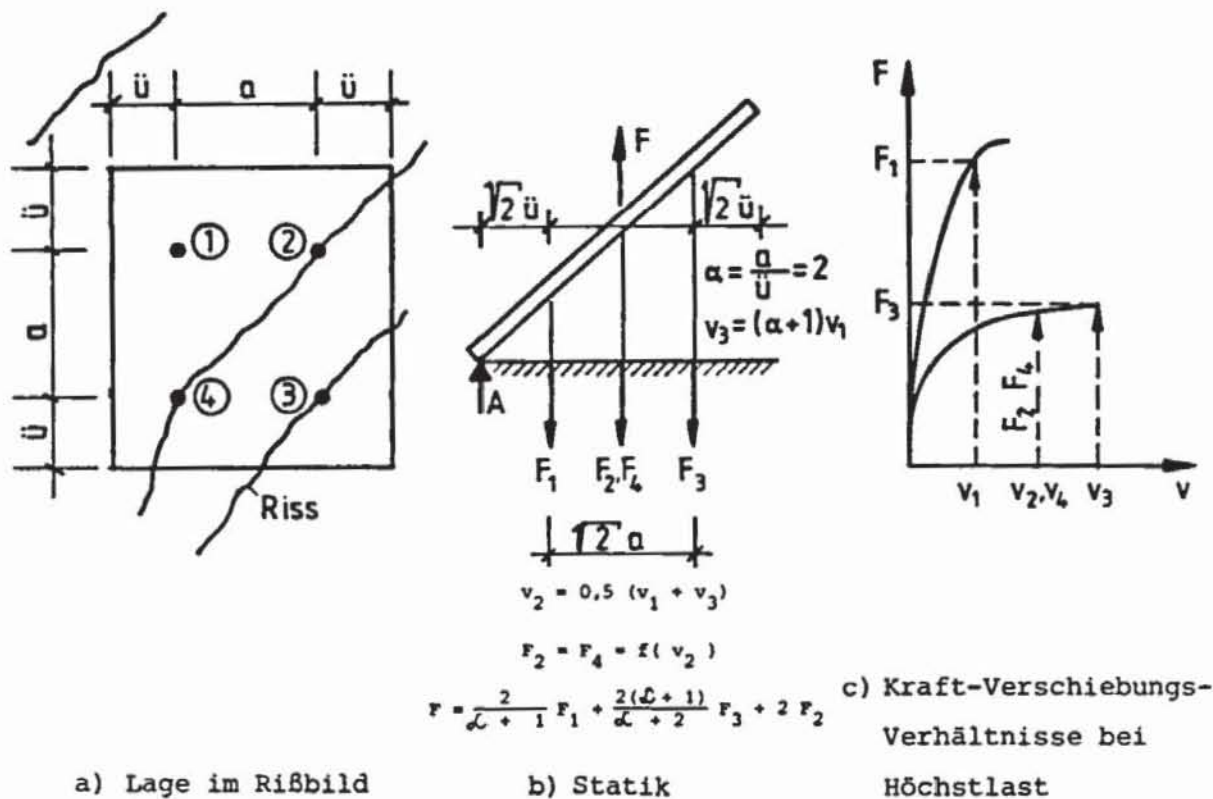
Gelenkig gelagerte Ankerplatte mit Abstützung am Beton.
